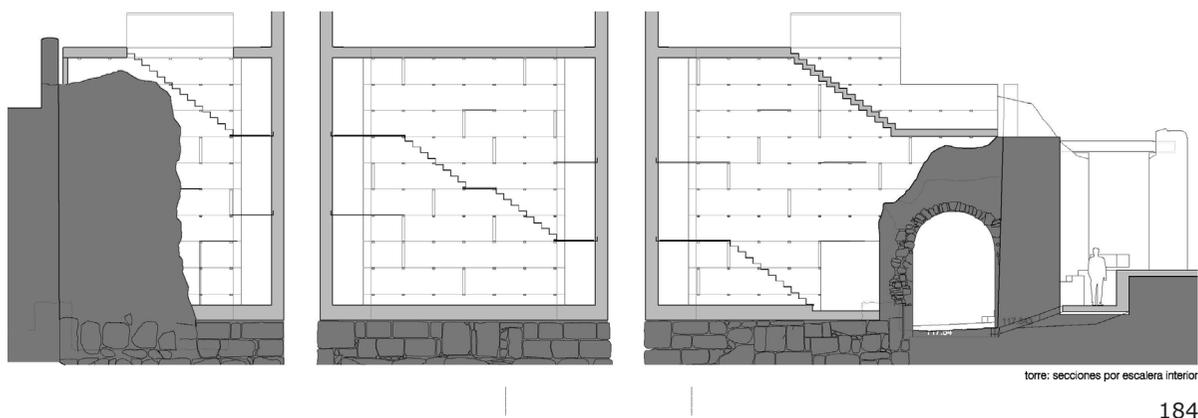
Alzado interior desplegado de la propuesta de reconstrucción de la torre.
